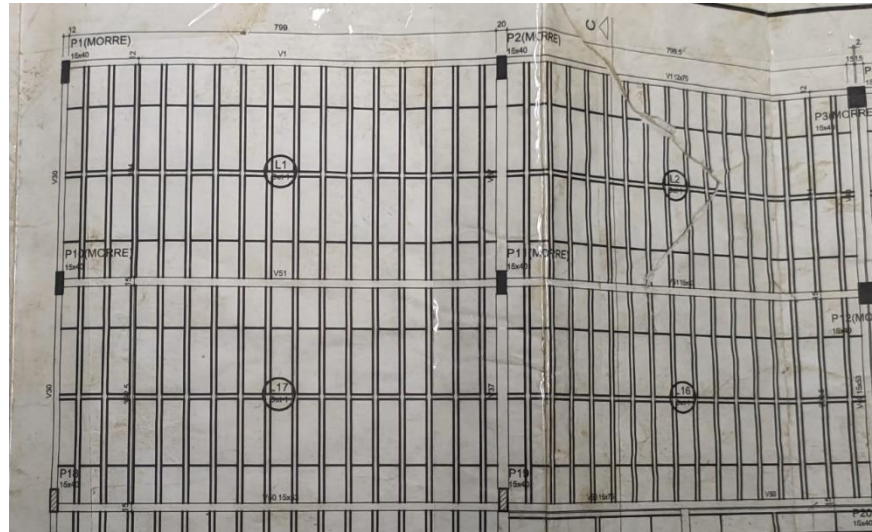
Localização das fissuras na V51 vão 1.
